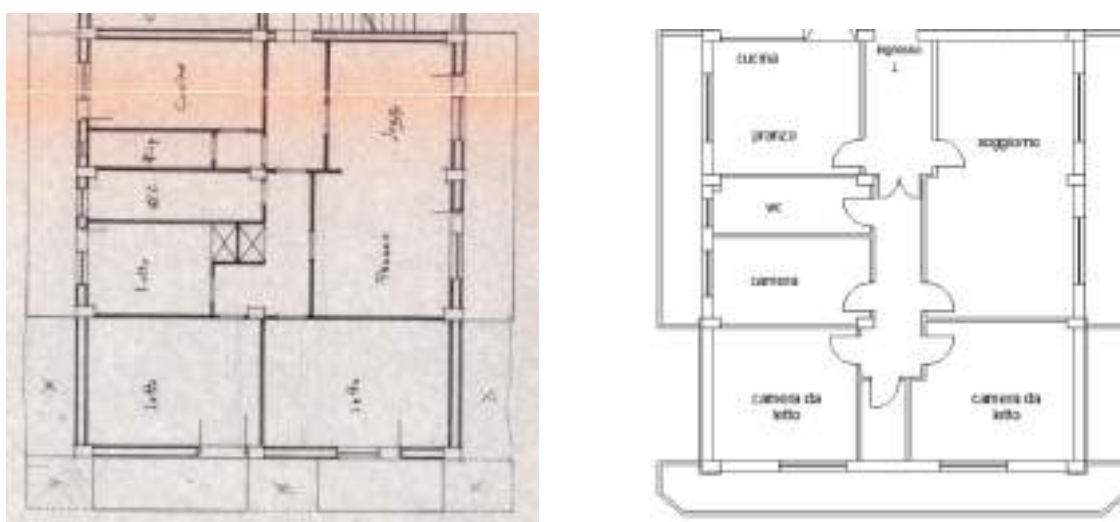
Piano terzo sub 3 - Confronto tra la planimetria “assentita” e stato di fatto.
